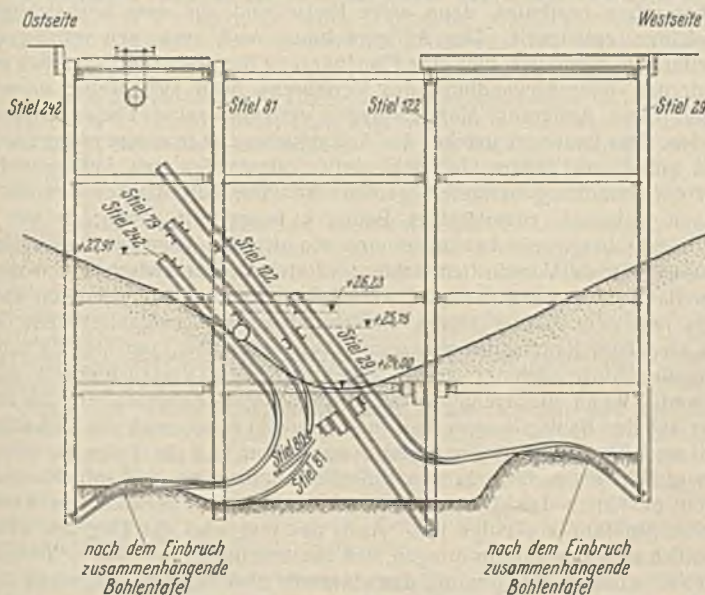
Querschnitt (an der Stelle A-B der Abb. 6 u. 13) der zusammengestürzten Baugrube.
